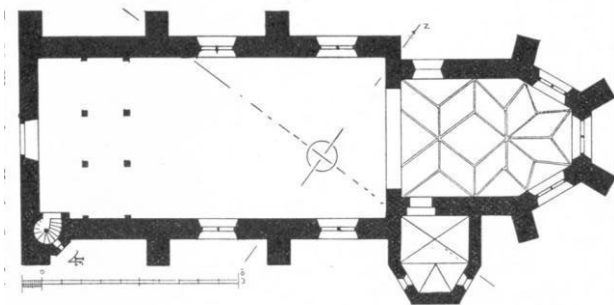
Wirzenborn, St. Maria, Grundriss
